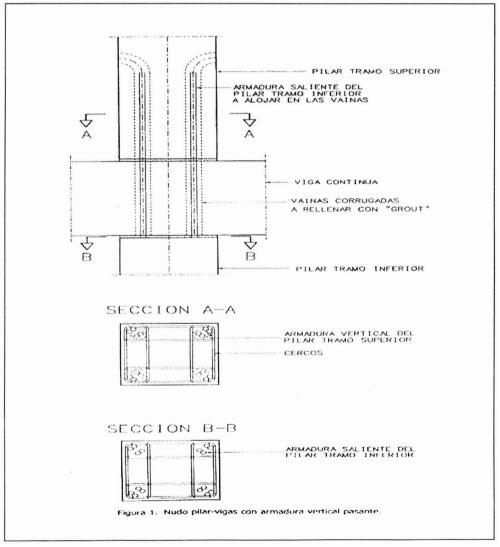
Nudo "pilar prefabricado-viga prefabricada" (solución viga sin interrupción).
